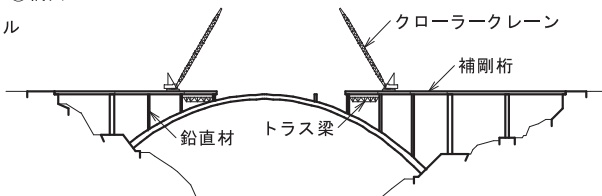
ロアリング工法の概要（神原溪谷大橋での施工順序）
